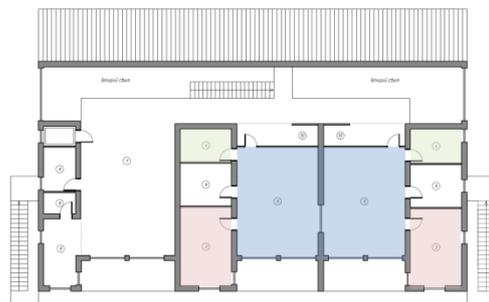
Планировочное решение второго этажа [3] детского сада общей площадью 960 м² для двух групп (г. Ридштадт)
